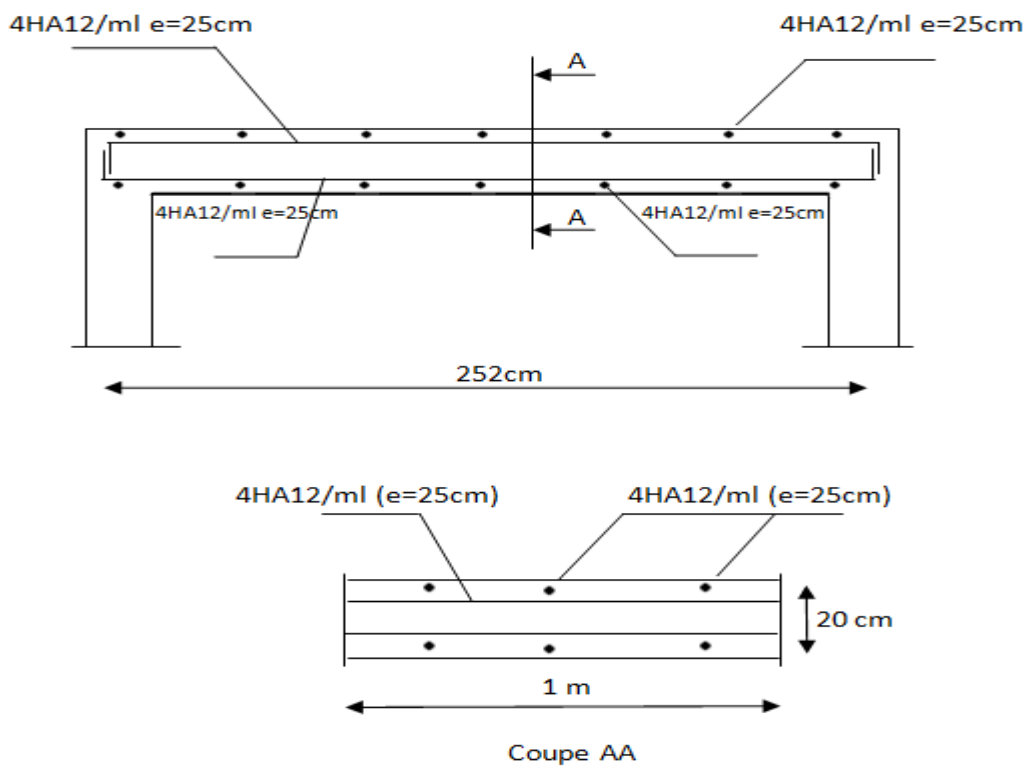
Ferrailage de la dalle du local machine dans le sens y-y.
